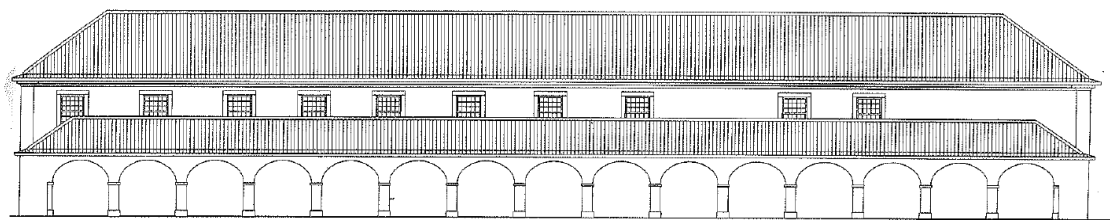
“Alçado Nascente – Casa da Câmara e Mercado.”
